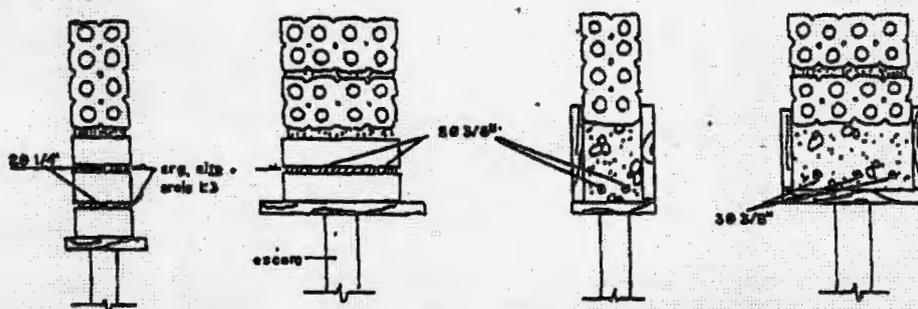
Vergas em alvenaria de tijolo furado para vãos até 1,00m e entre 1,00m e 2,00m
